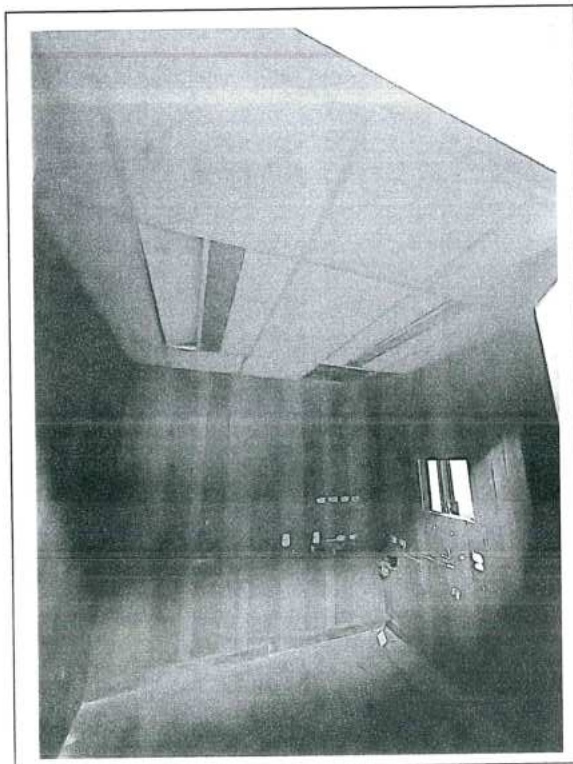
IMAGEN MUROS DE DRYWALL EXISTENTES CON SUPERFICIE DE LISTONES DE MADERA EN SEGUNDO NIVEL ZONA DE HALL
